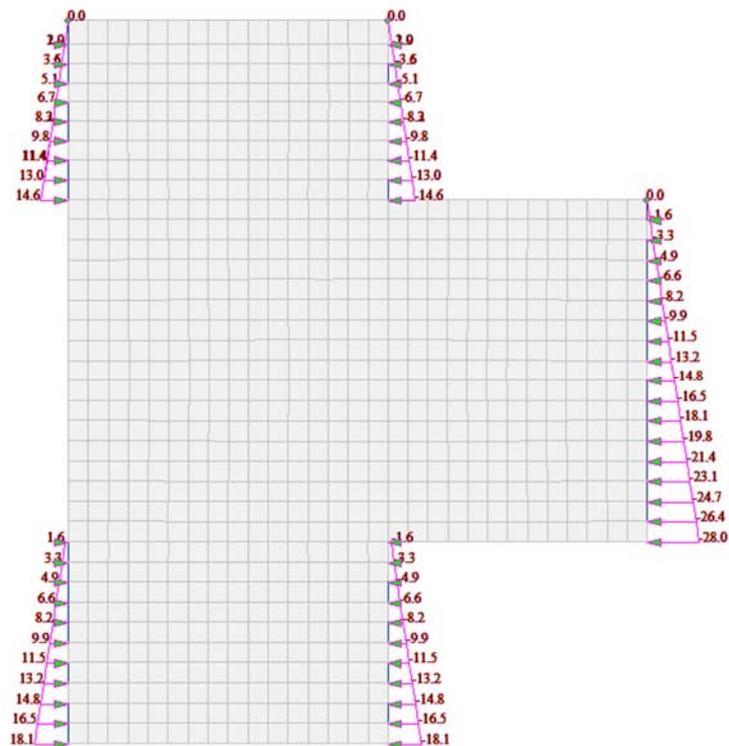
Spinte del terreno in direzione X (pareti Y)
